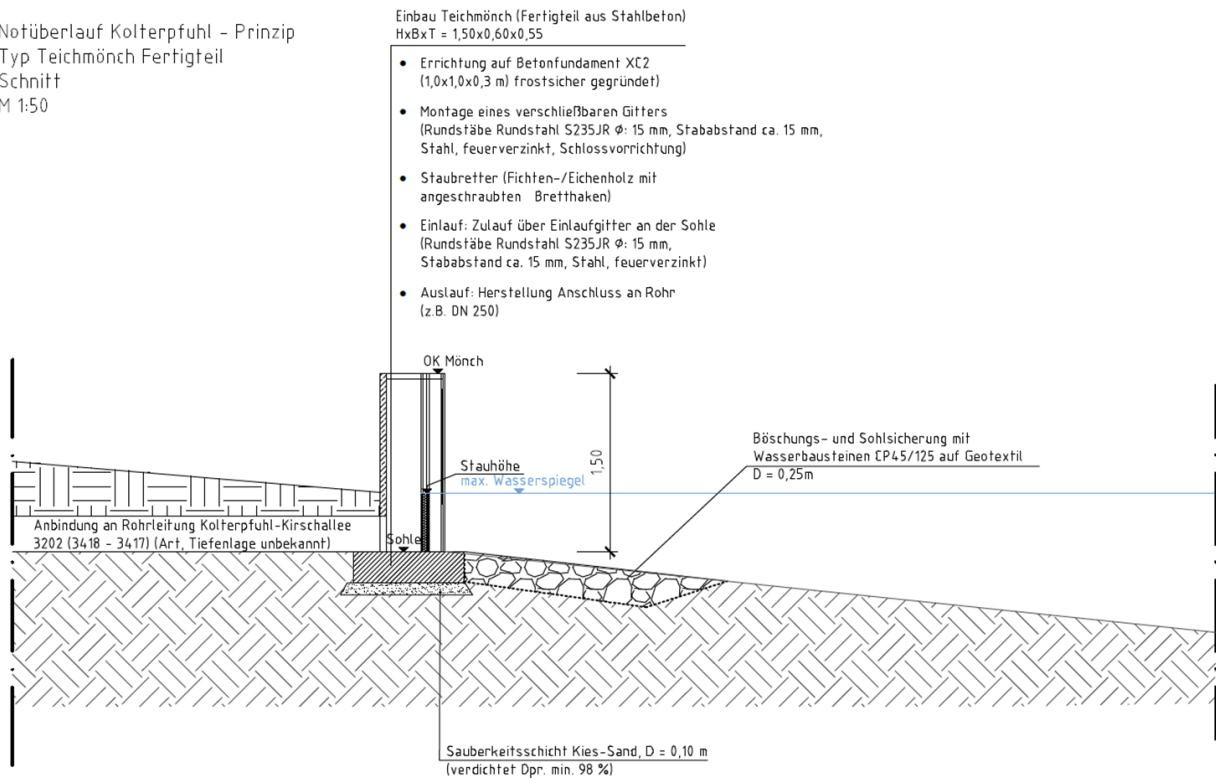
Notüberlauf Kolterpfuhl Teichmönch Schnitt
